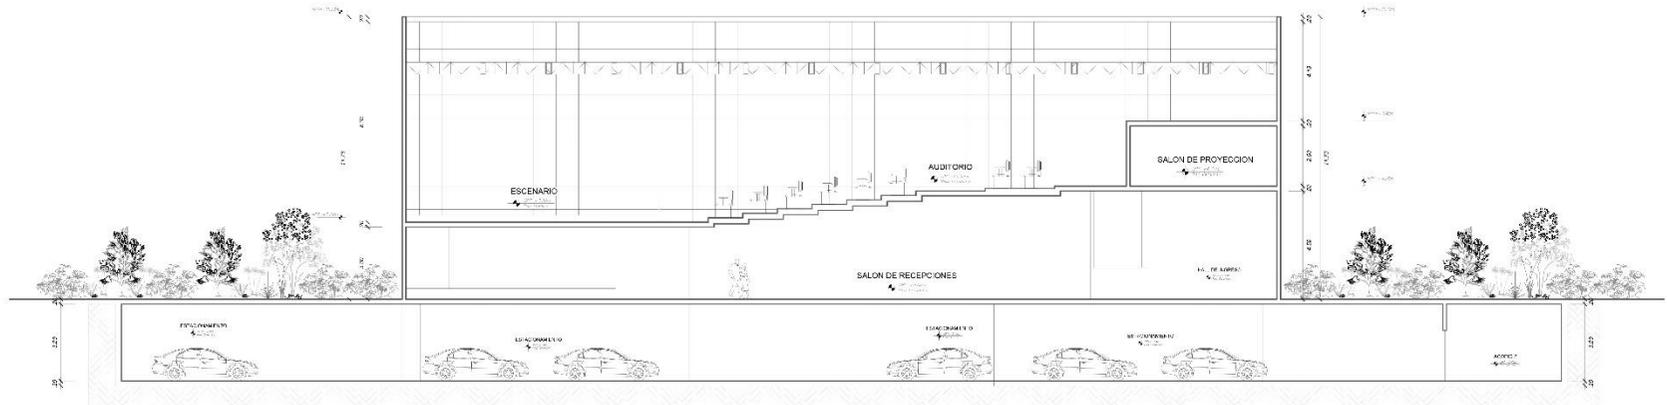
Plano de Arquitectura Corte 3-3. Elaboración propia
